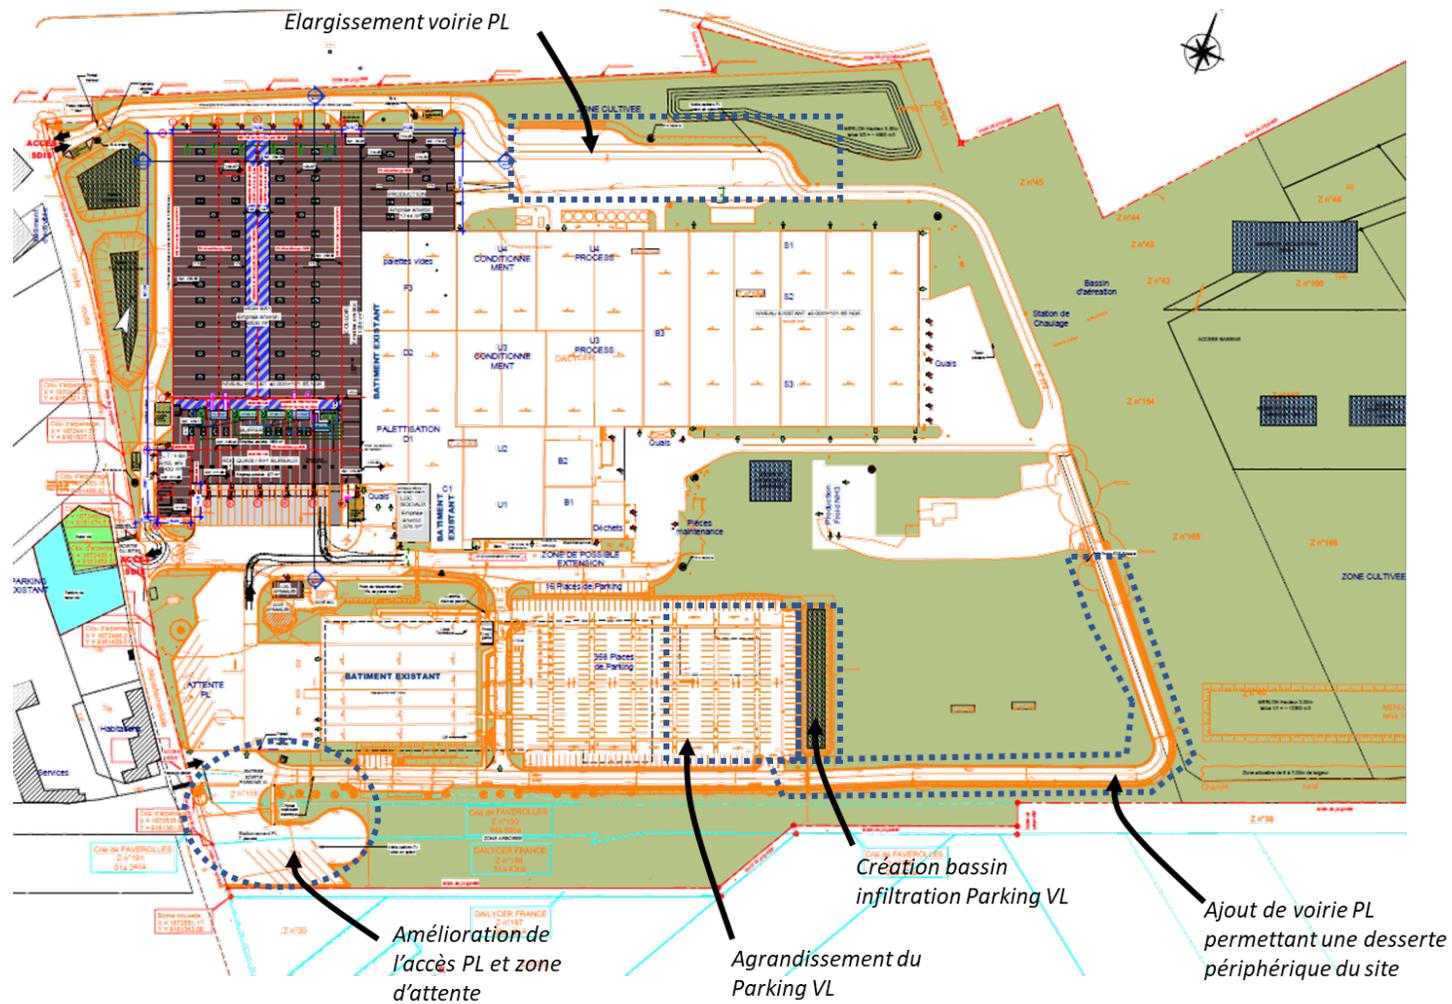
Schéma de porter à connaissance des adaptations apportées au plan masse en 2021
